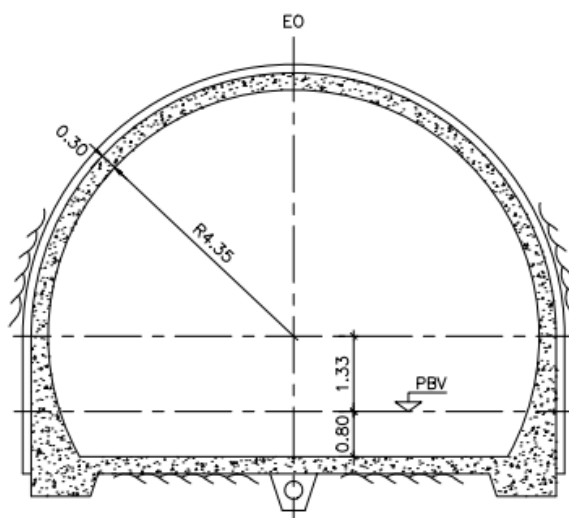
Revestimento secundário do túnel existente (Prolongamento da Linha Vermelha Alameda II – São Sebastião II, Estruturas, Término, Tímpano provisório, Plantas e Cortes-Des. n.º9588 F. 1/1, maio de 2002)
